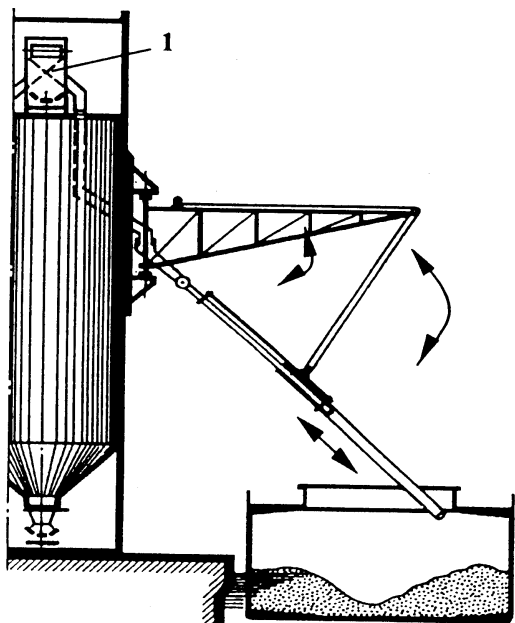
Отпускная самотечная труба, подвешенная на стене силоса:
